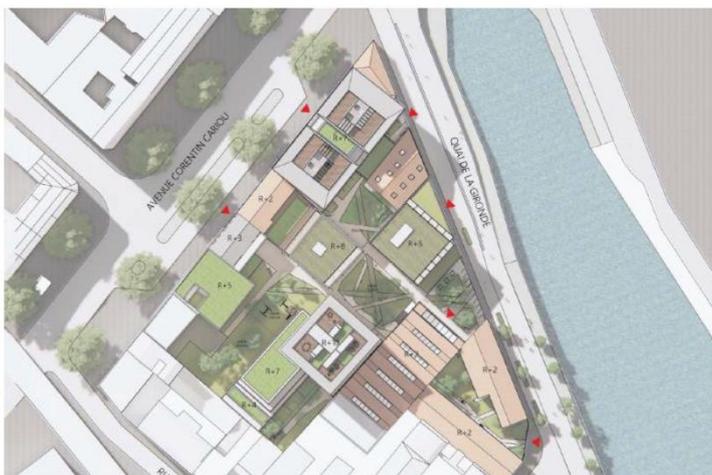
Plan masse du projet (source : étude d'impact, p. 31)
